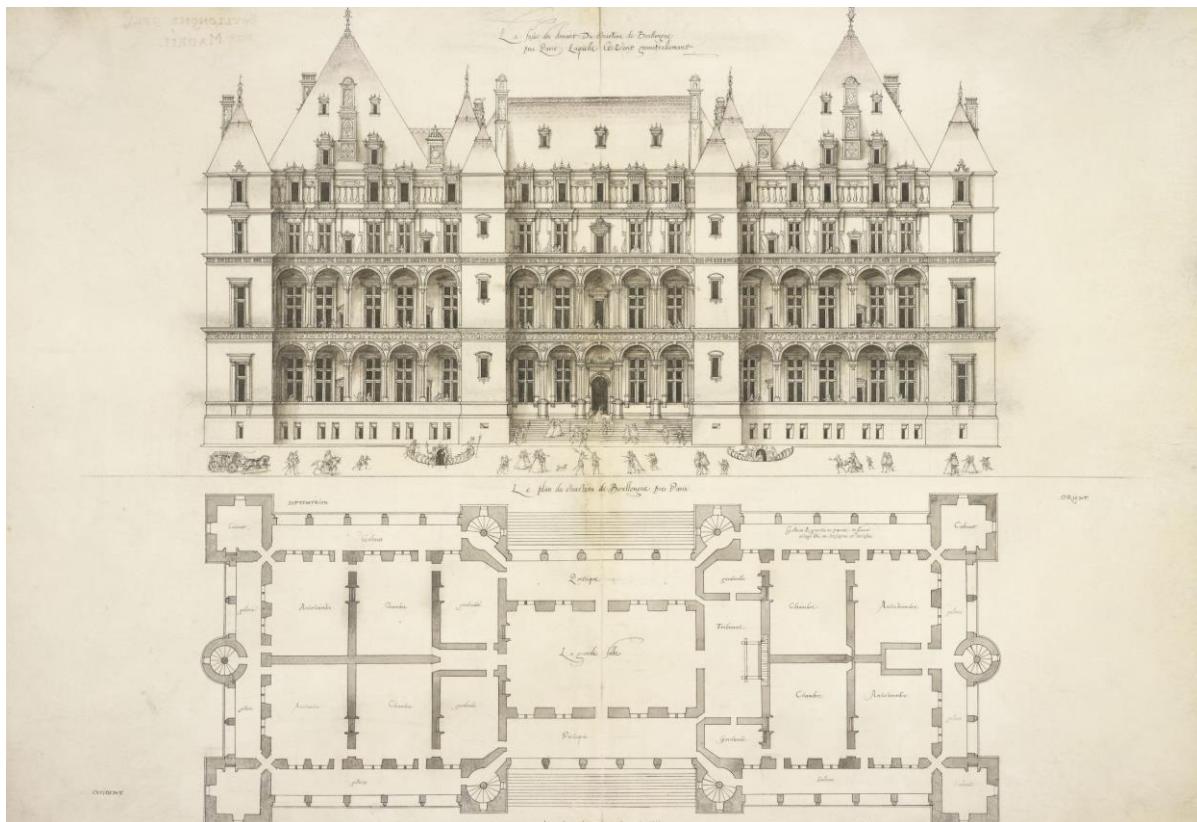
Jacques Androuet du Cerceau, Château de Madrid / Château de Boulogne, Aufriss und Grundriss, um 1570
